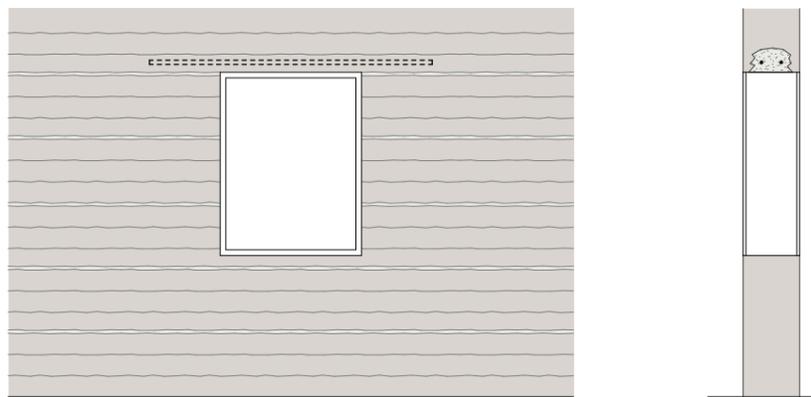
Kleine Fensteröffnung mit bewehrtem Lehmsturz
